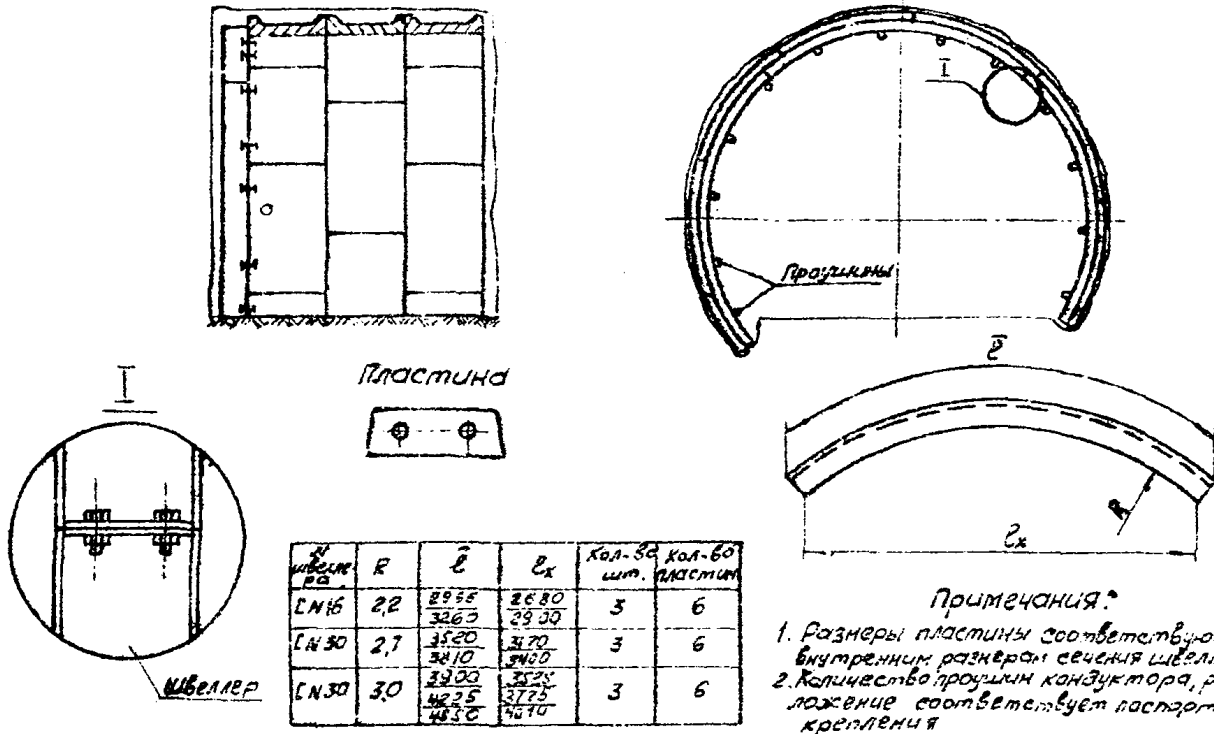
Кондуктор для установки первой арки тубинговой крепи
